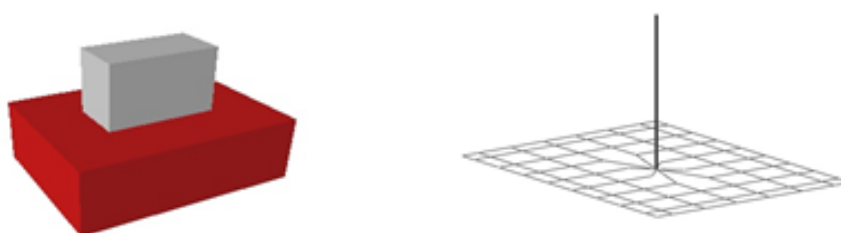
Imagem esquemática da estrutura do pilar de apoio.
